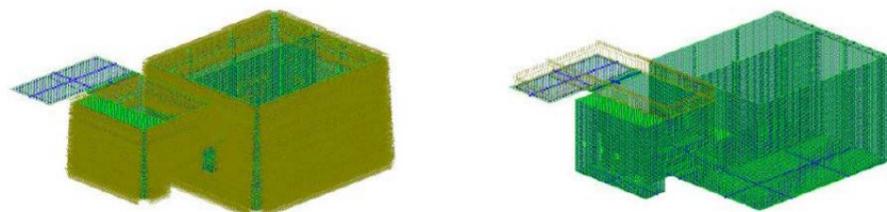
Нагрузка грунта на стенки (слева) и нагрузка от здания (справа)
